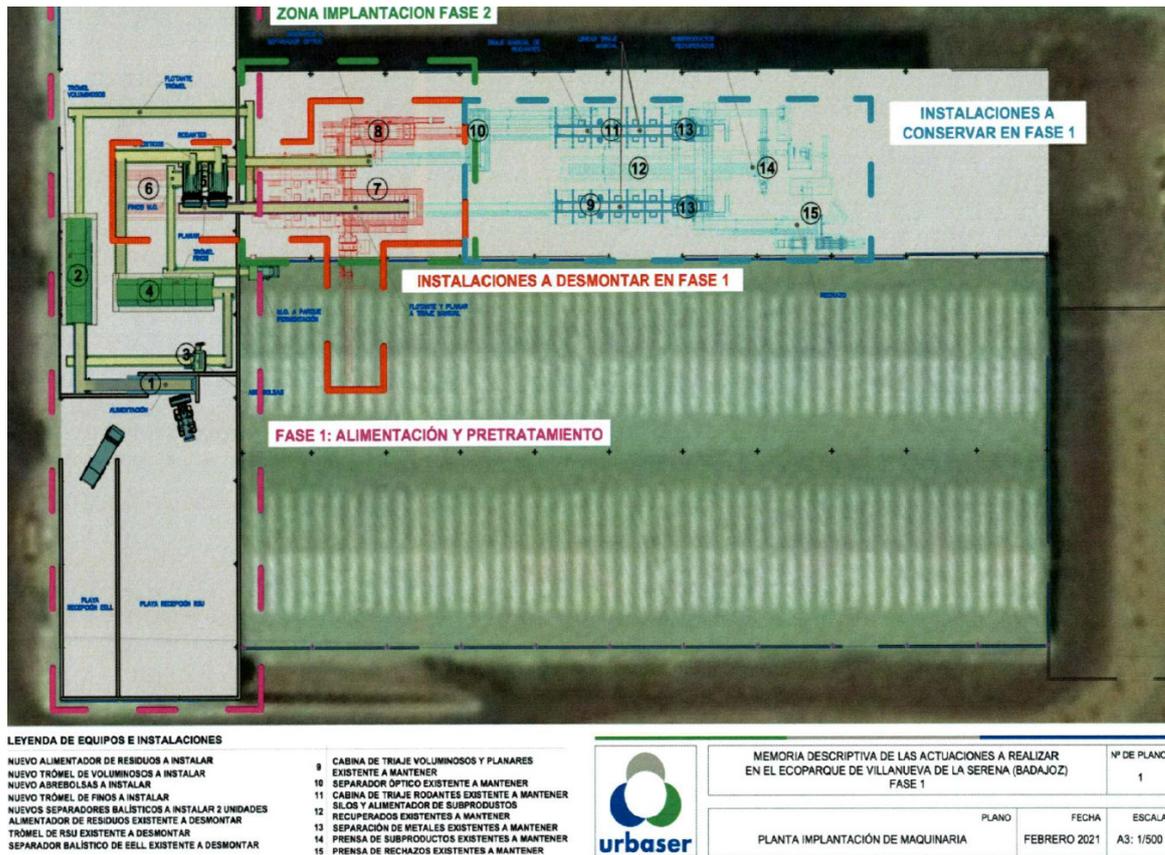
Plano en planta de la instalación. Zona de tratamiento.
